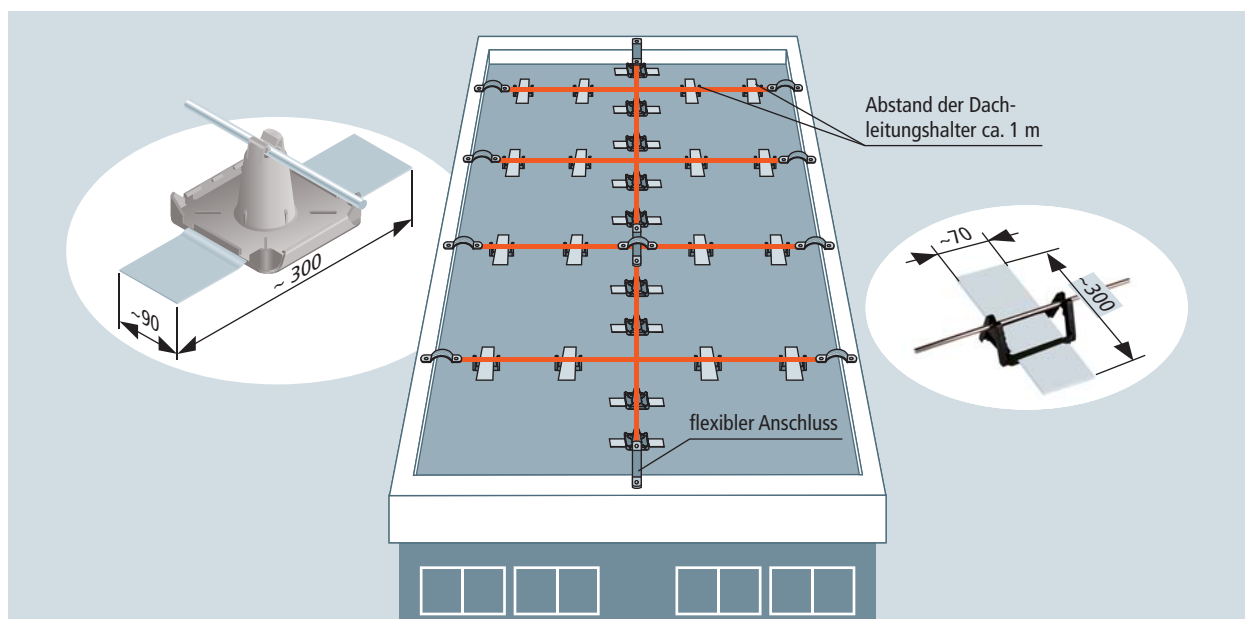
Kunststoff-Flachdachbahnen – Dachleitungshalter Typ KF/KF2
